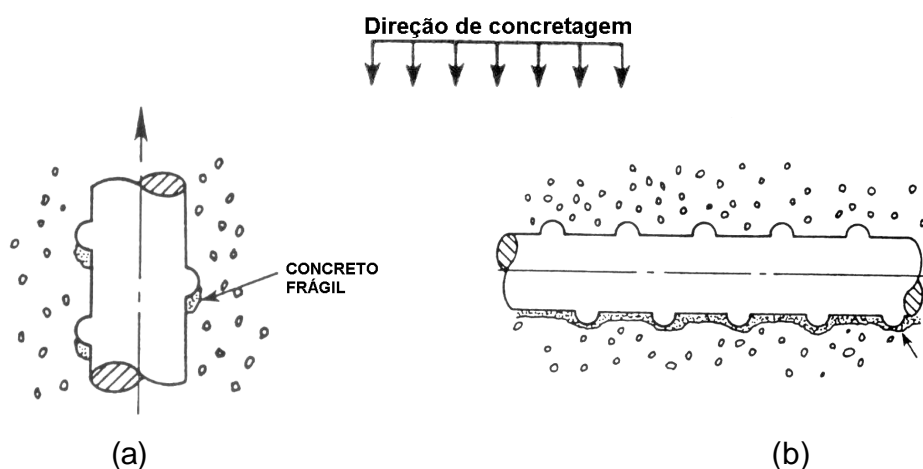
Direção de concretagem. a) barra de aço concretada verticalmente; b) barra de aço concretada horizontalmente.
